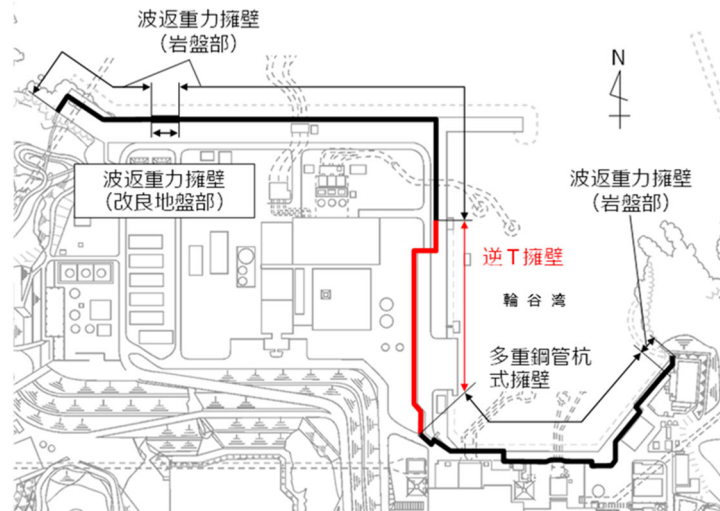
防波壁（逆T擁壁）の平面配置図
